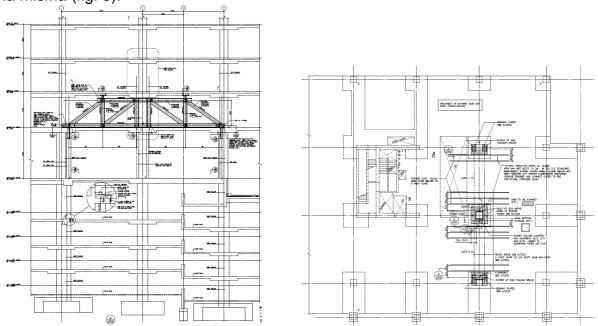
Corte vertical de la estructura del edificio y esquema parcial en planta del 1er. piso.
